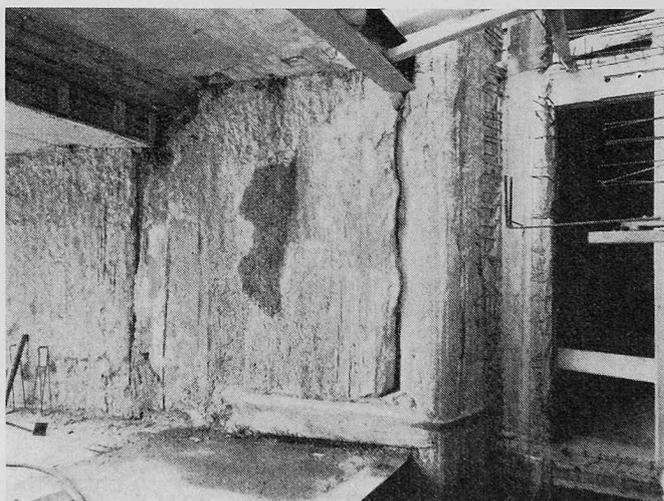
Auflagerung einer Deckenkonstruktion auf einer Schlitzwand
